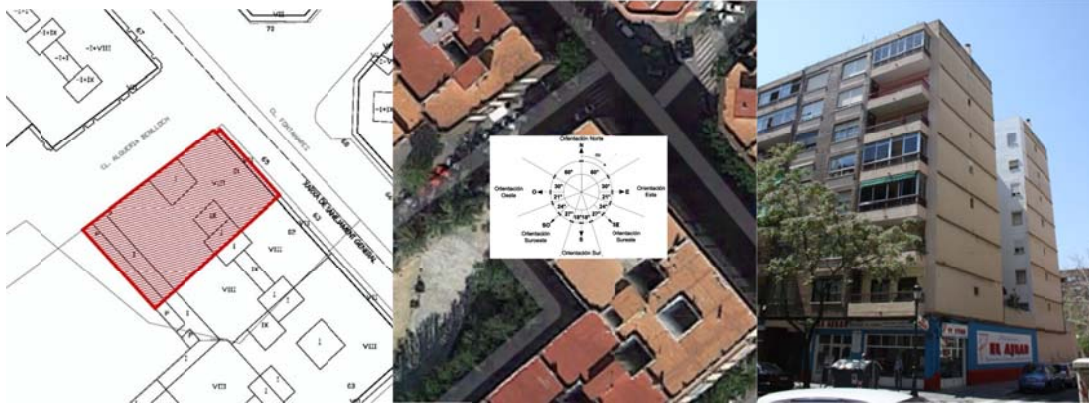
Emplazamiento del edificio, foto aérea y fachadas de c/ Fontaneres y c/Alquería de Benlloch. Fuente: (1) L'Eixample Arquitectes Associats. (2) Google maps, (3) IVE.
